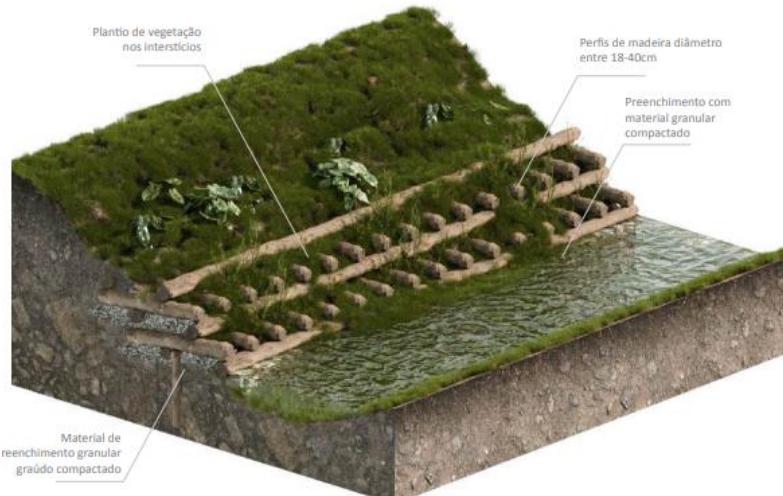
Muro de suporte vivo em madeira tipo cribwall (Fonte: Guajava. Adaptado de Helgard Z., 2007).
